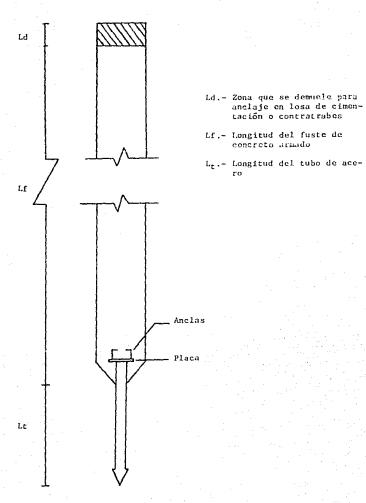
PILOTE PENETRANTE (PUNTA\_FRICCION).
